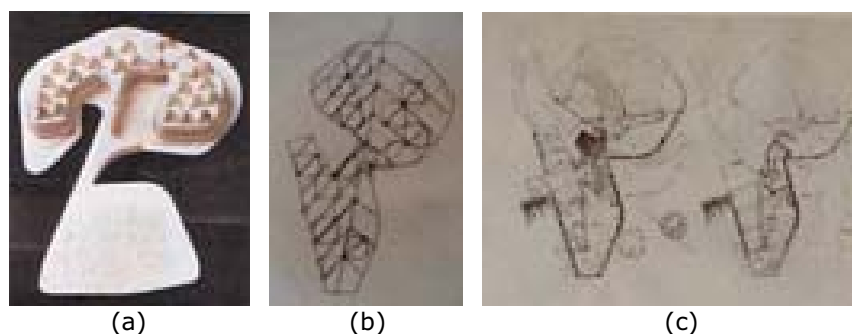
(a) Proyecto para Oficina de Venta de automóviles. (b) (c) Plantas de Palafolls primera propuesta.
